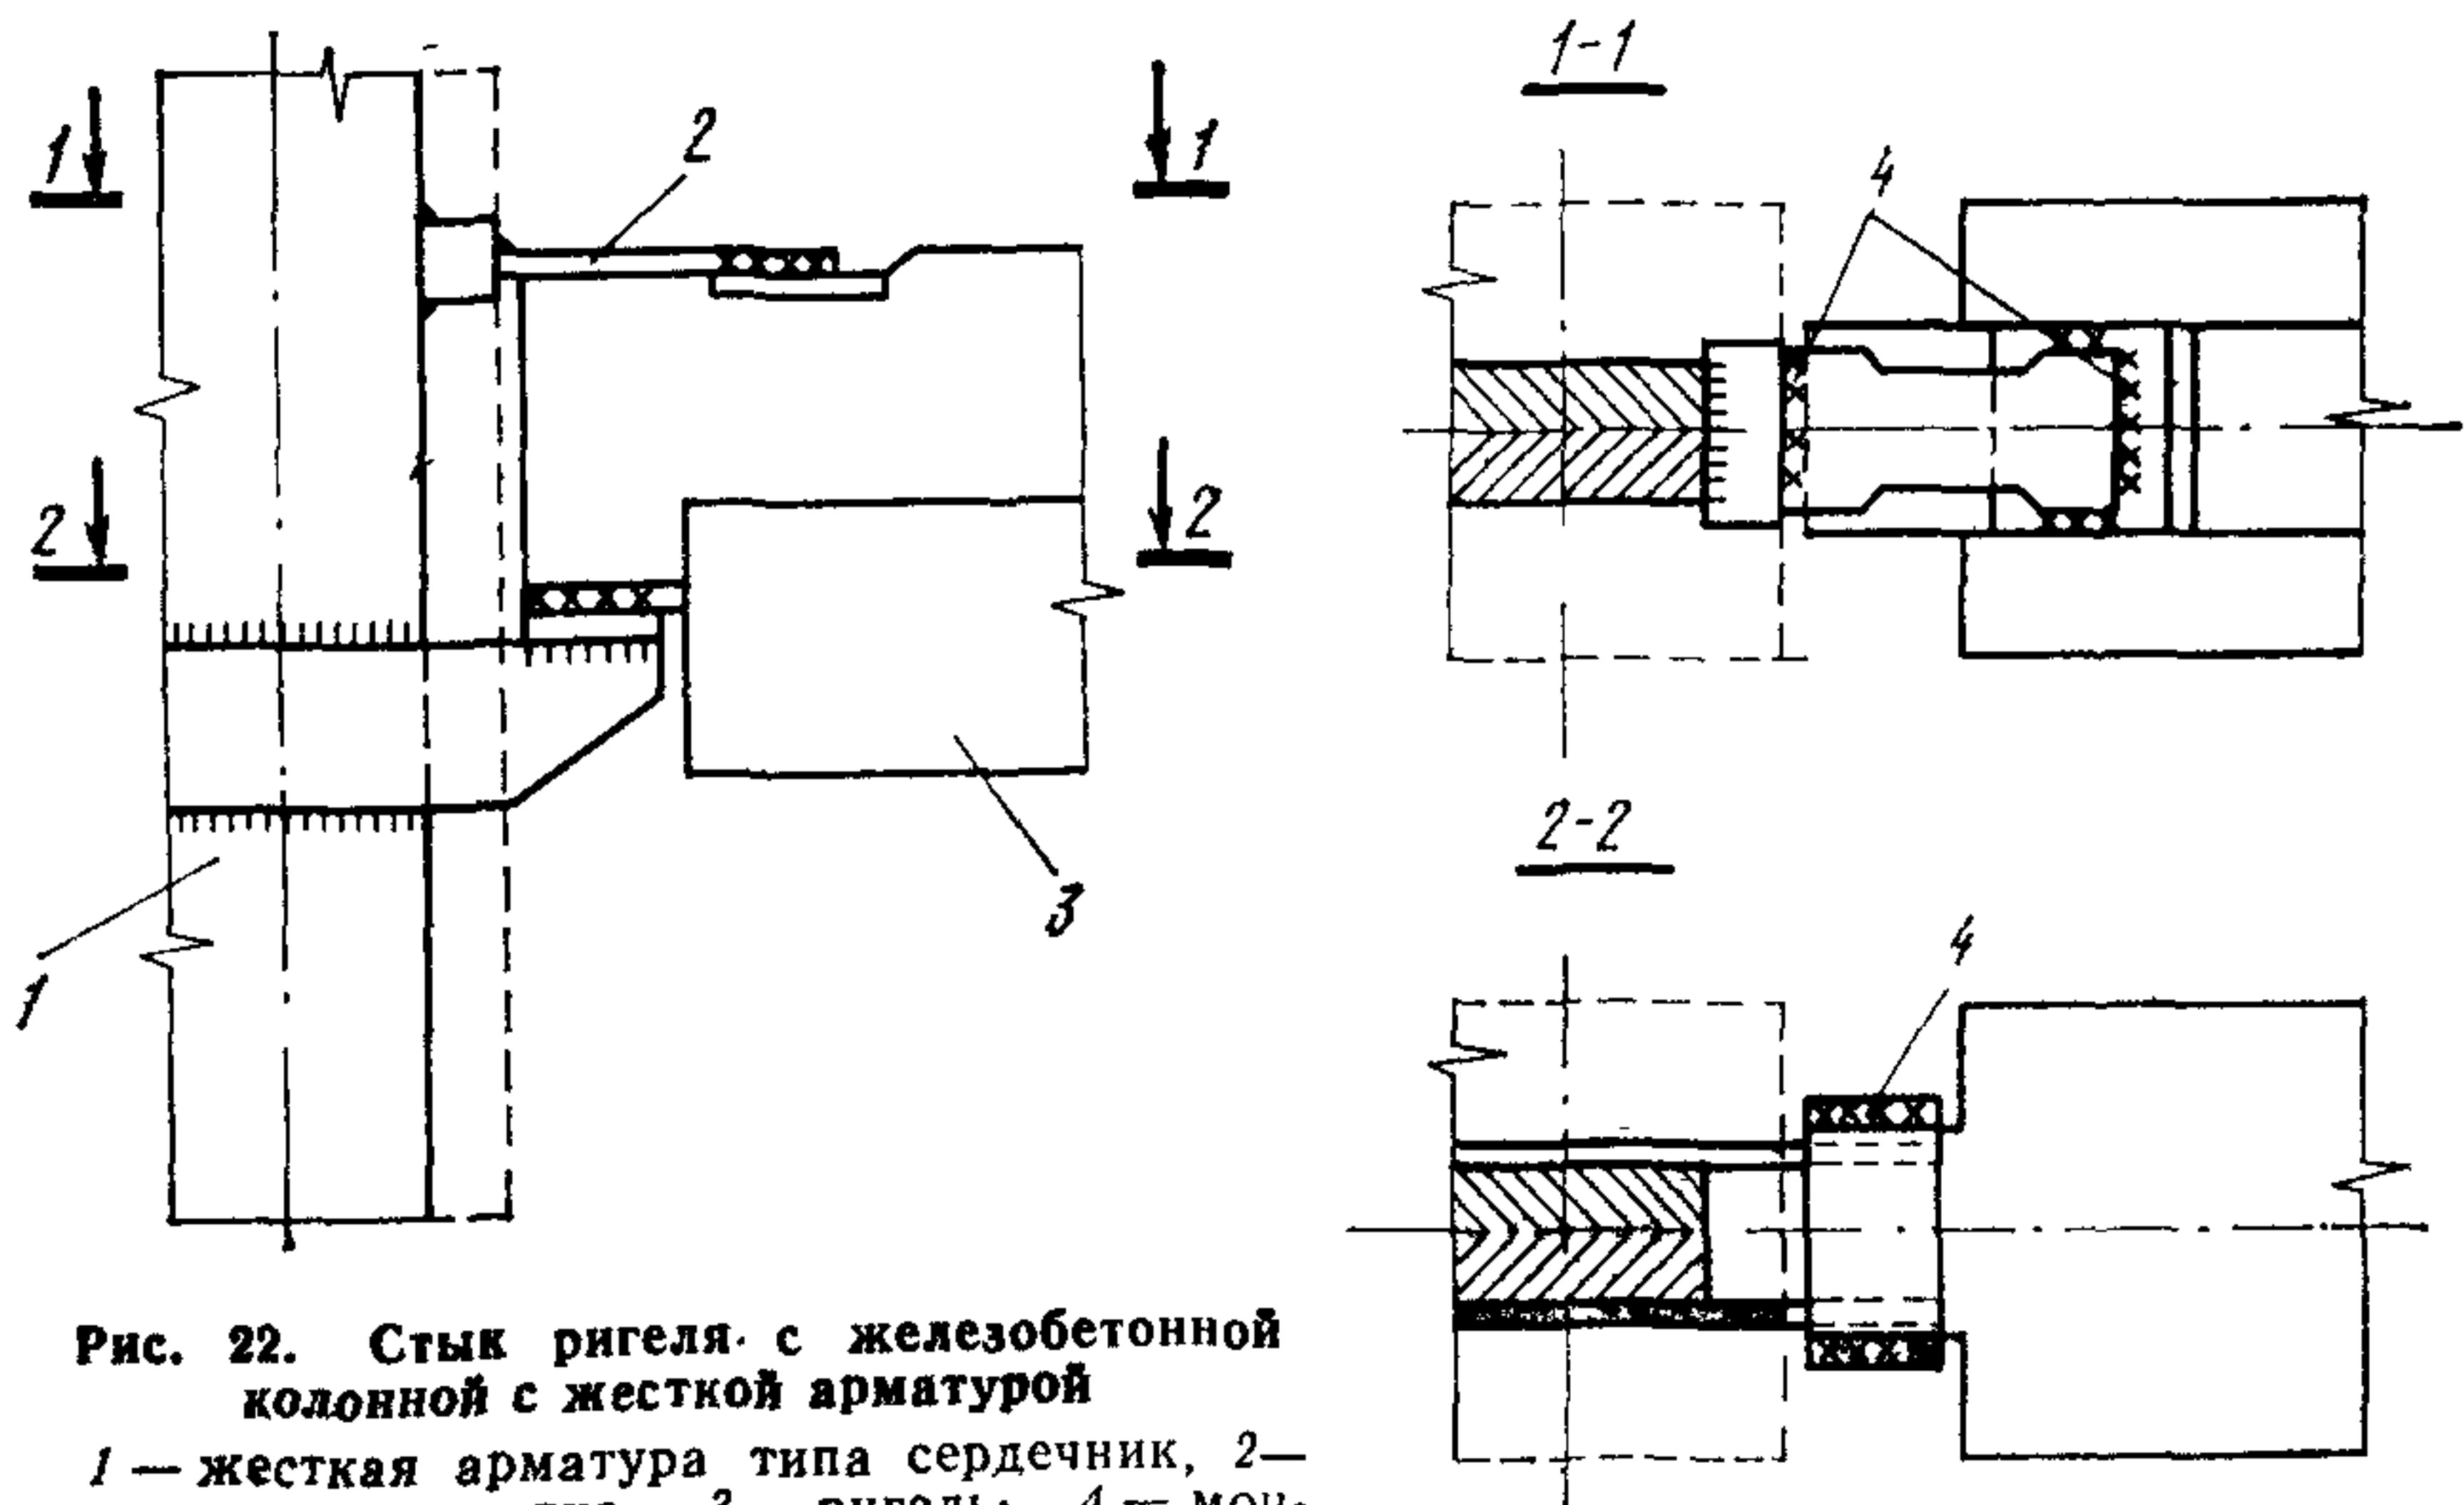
Стык ригеля с железобетонной колонной с жесткой арматурой
